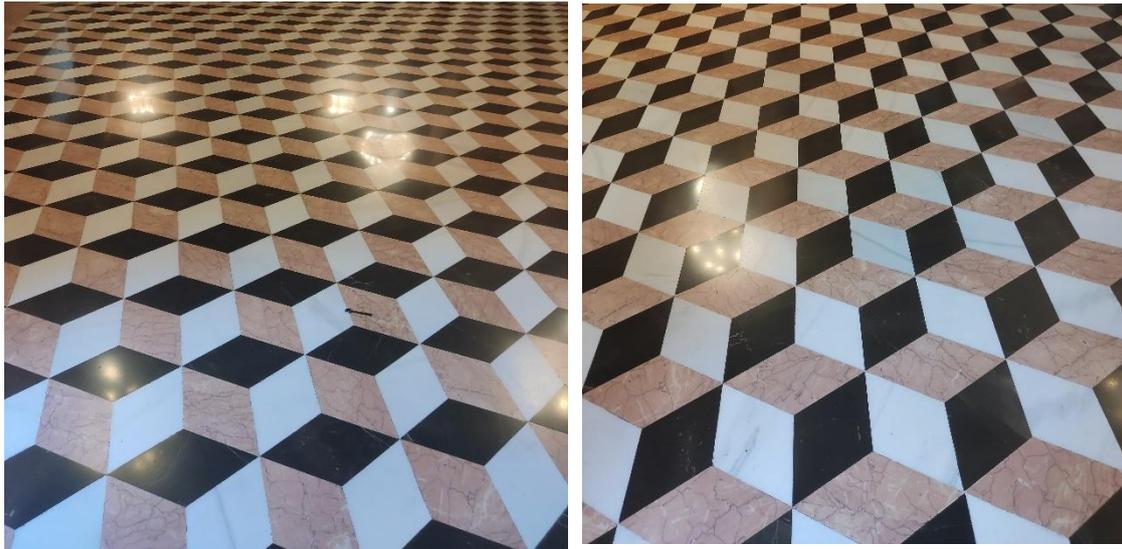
Pavimento planta superior del Pabellón del Consulado del Mar la Lonja de Seda.
